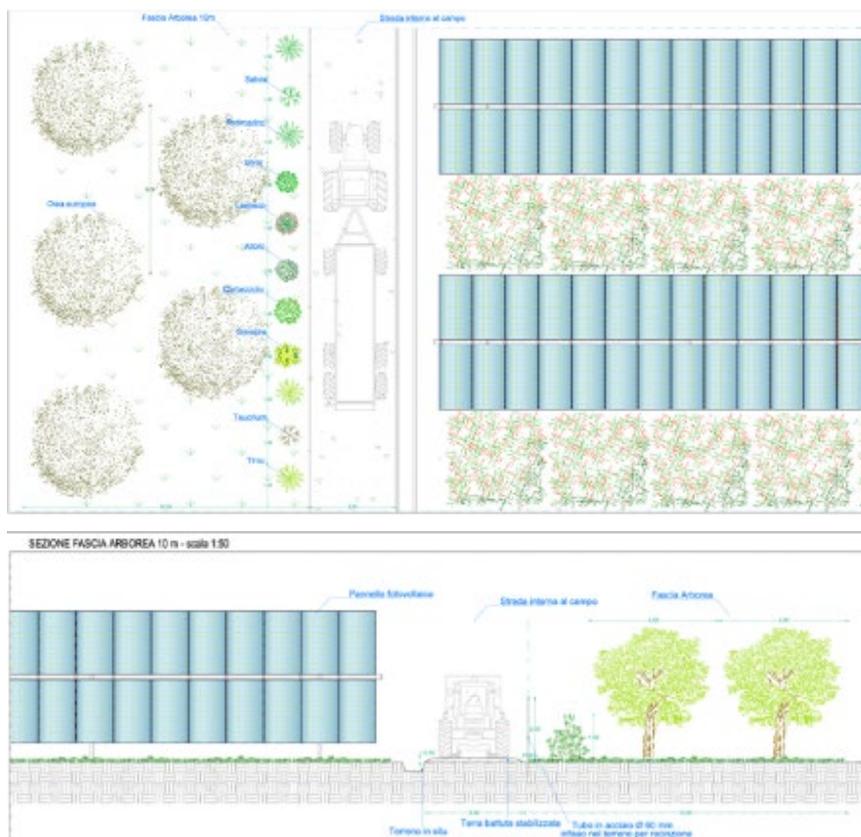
Planimetria degli interventi di mitigazione⁷⁴
